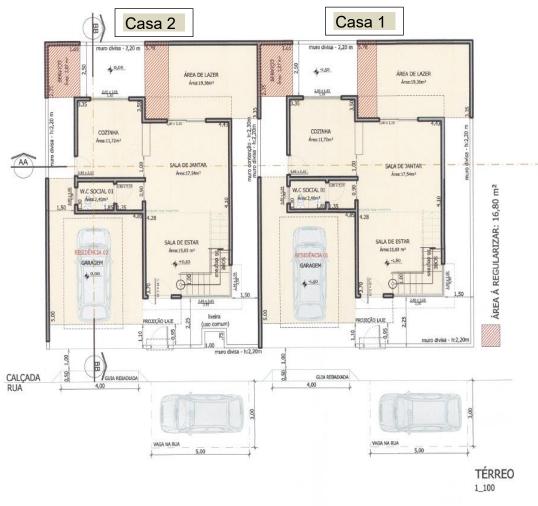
Planta Baixa Pavimento Térreo – Estudo de Caso 1
